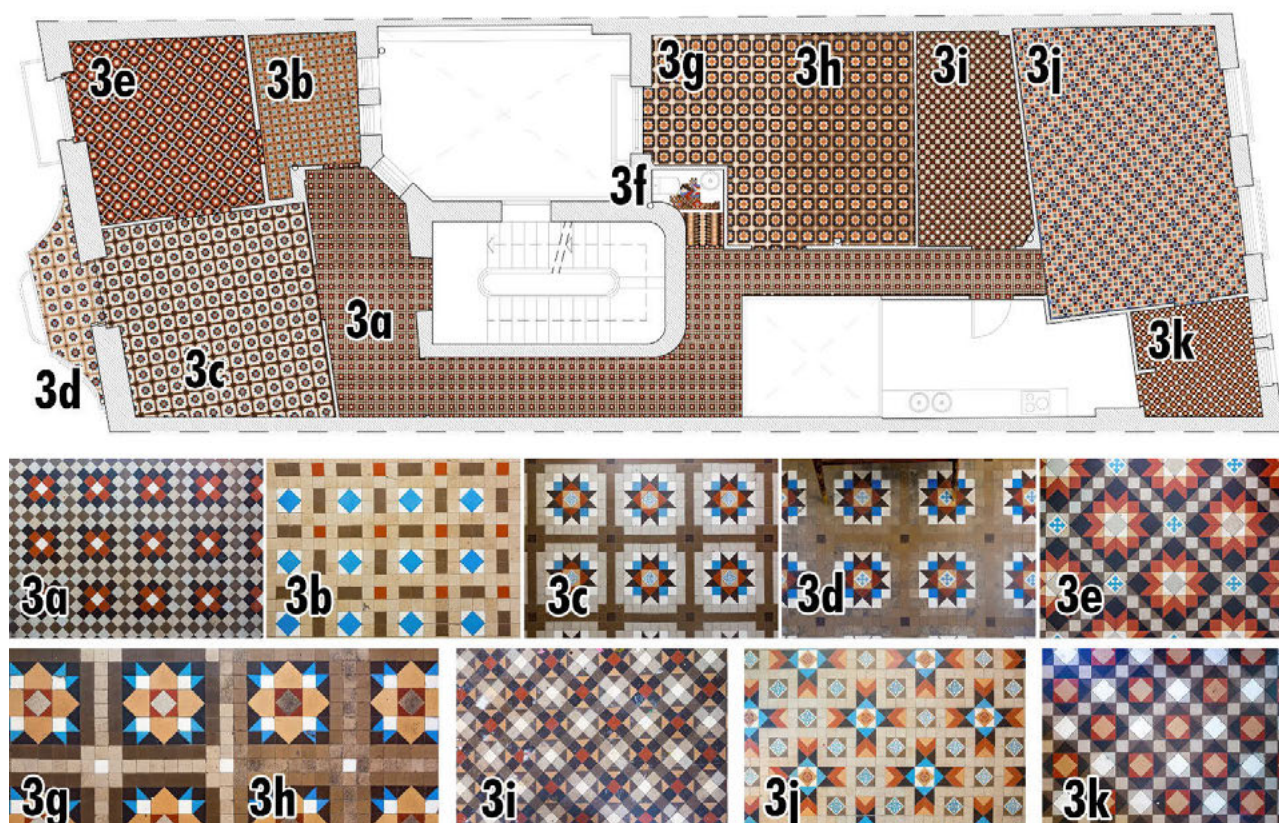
Esquema de los pavimentos situados en planta tercera. Se identifican los modelos en planta y con fotografías de los mismos. Desde el modelo 3a hasta el modelo 3k
